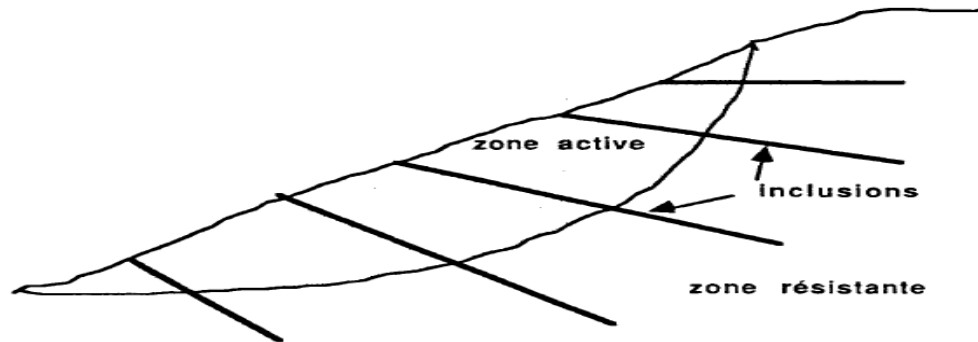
Stabilisation d'une pente instable par clouage[17]
